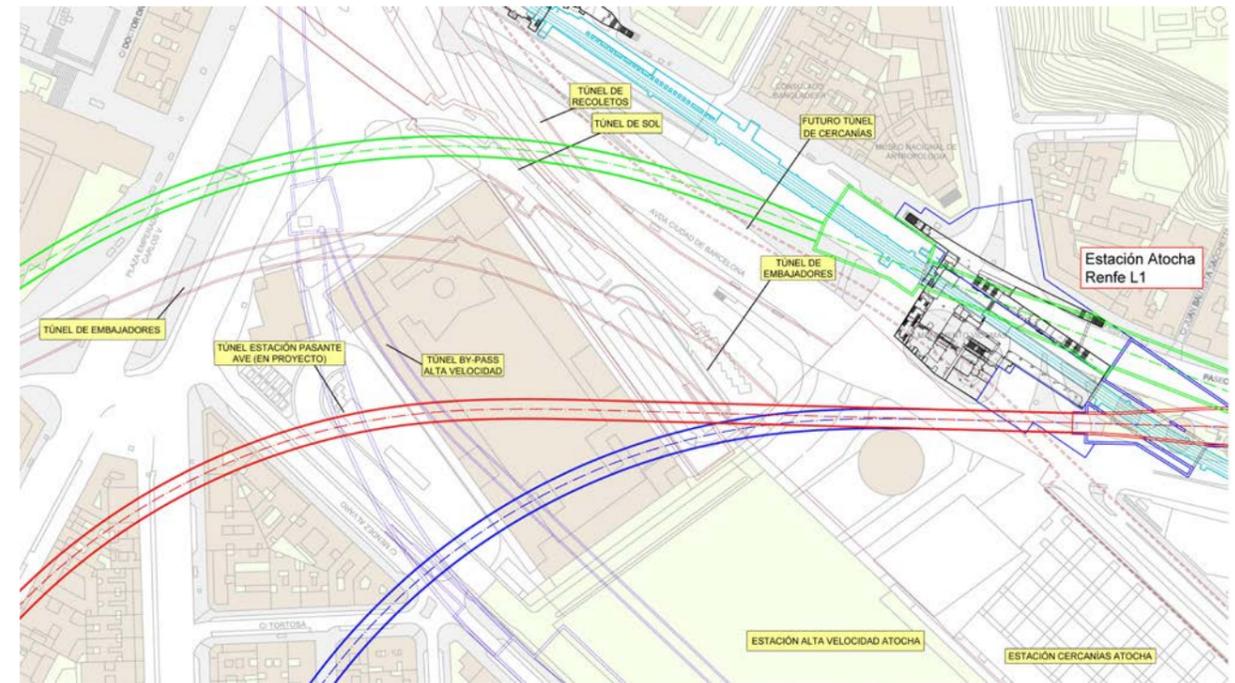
Planta Estación de Atocha con estructuras subterráneas
